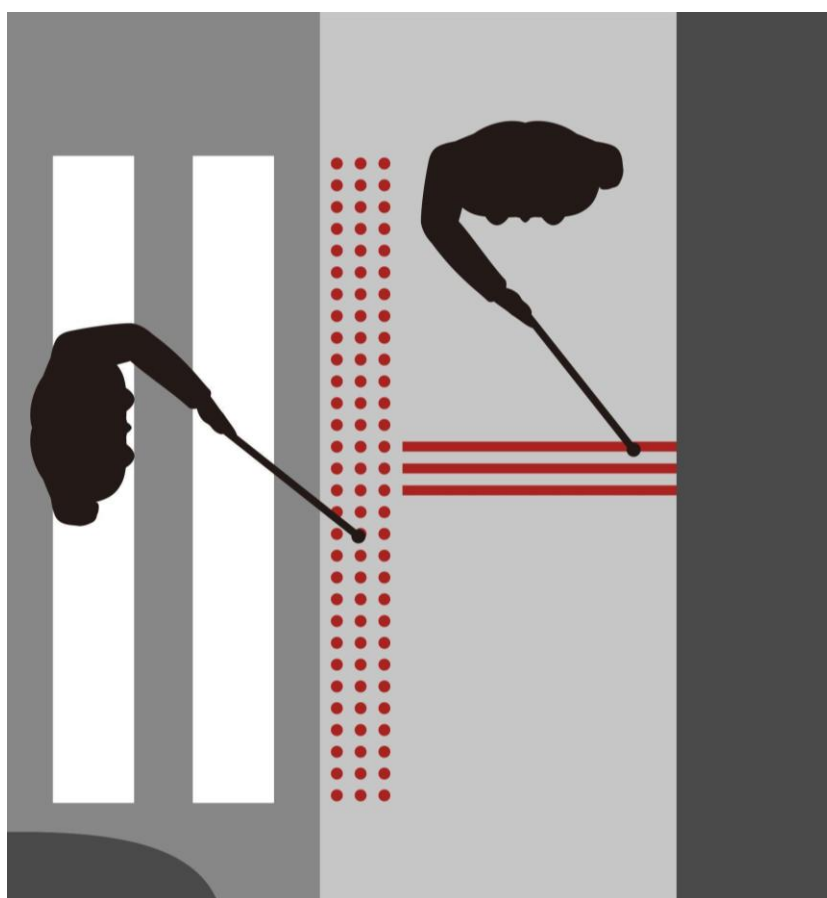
Schema planimetrico che illustra l'uso della pavimentazione tattile per segnalare un attraversamento pedonale. Avvicinandosi dal marciapiede, gli elementi lineari indicano la presenza dell'attraversamento, mentre la superficie con motivo a cerchi segna la soglia. Provenendo dall'attraversamento, gli elementi lineari guidano la persona verso la facciata dell'edificio più vicina, che può essere utilizzata come linea guida naturale per l'orientamento (Opera degli autori).
